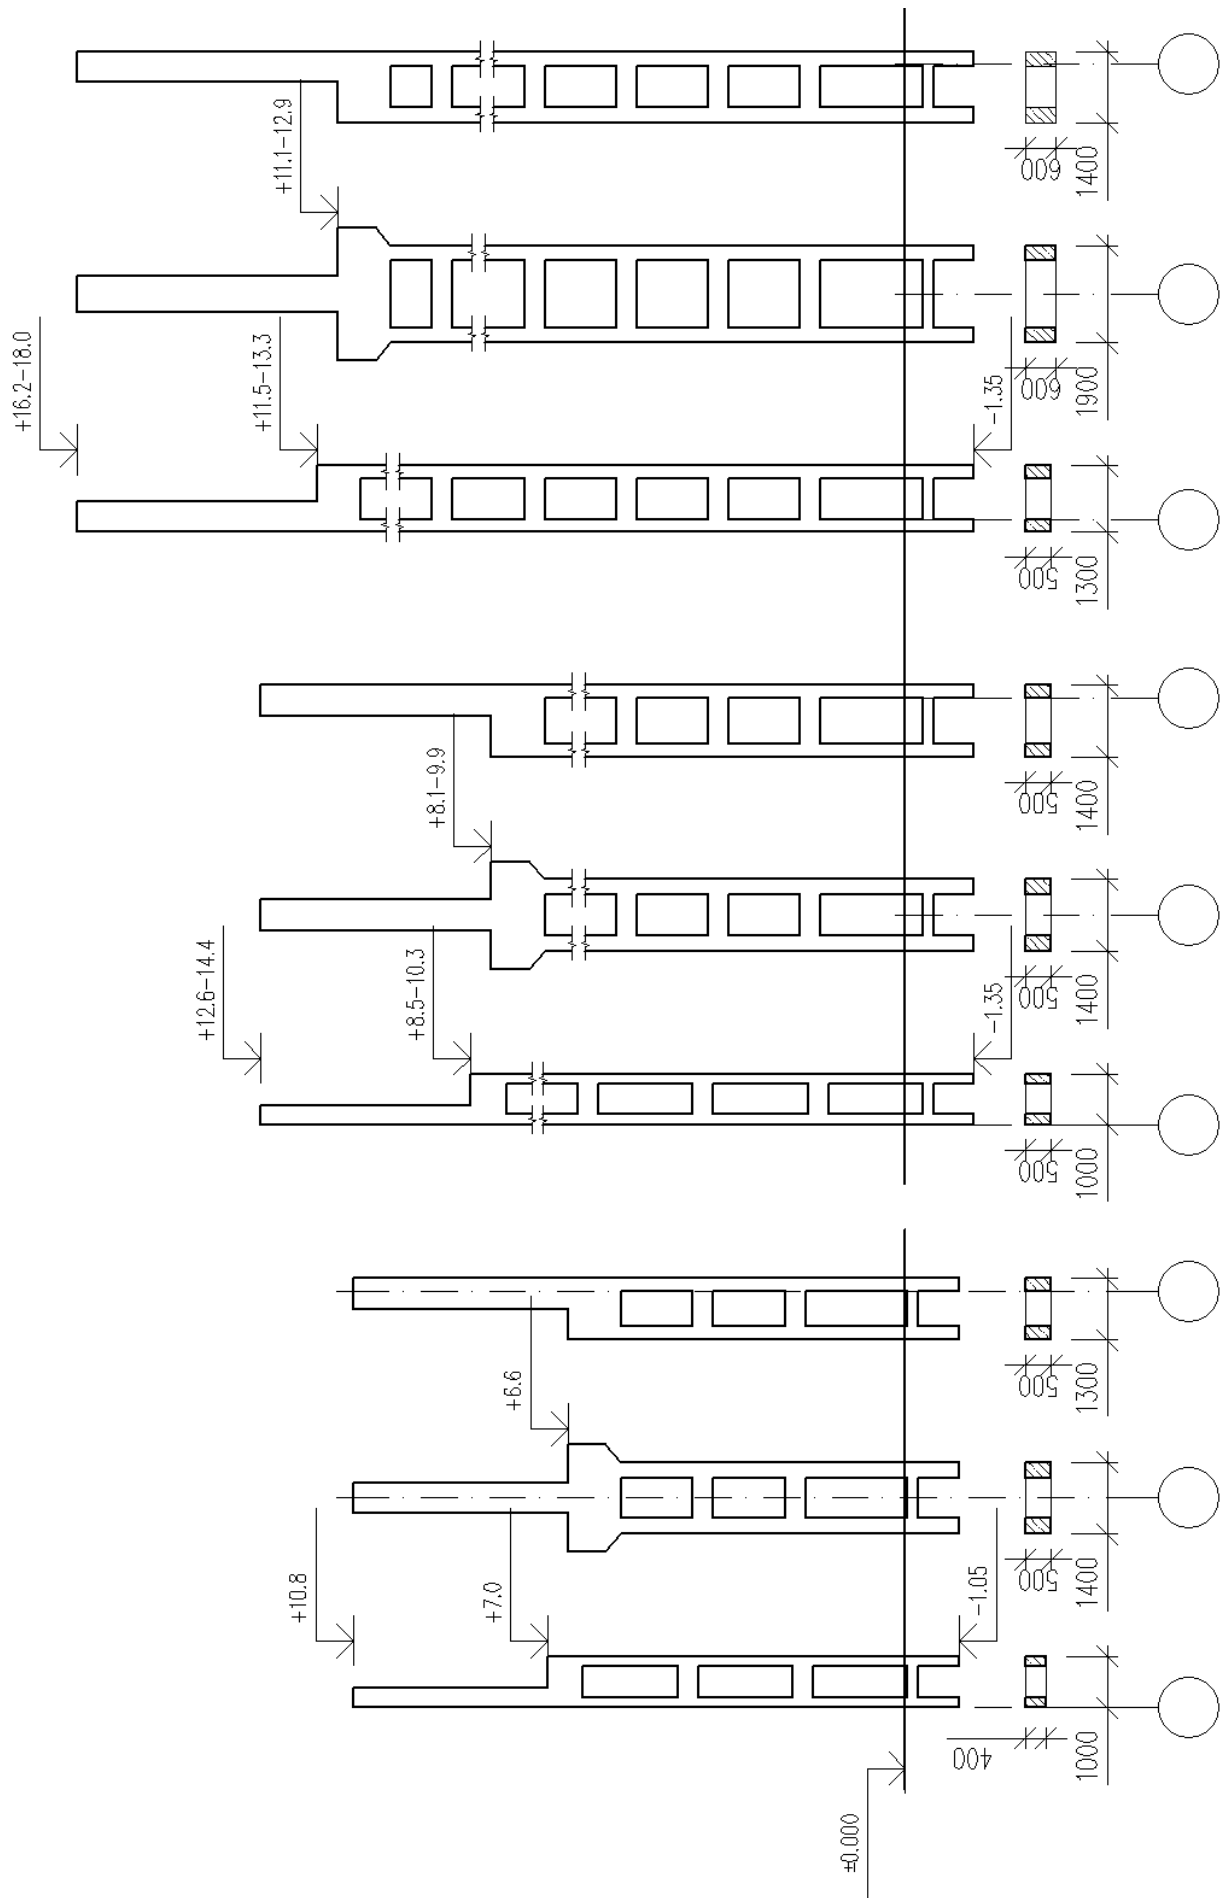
Железобетонные двухветвевые колонны для зданий с опорными кранами грузоподъемностью 10 – 50 т (серия КЭ-01-52)
